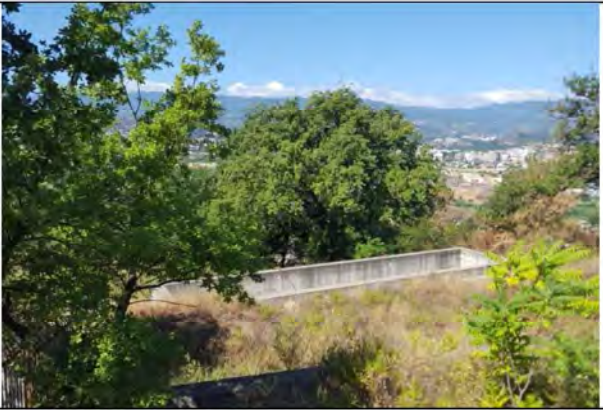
e 47. Struttura rettangolare della piscina esterna.
